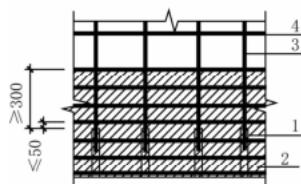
钢筋套筒灌浆连接部位水平分布钢筋的加密构造示意
